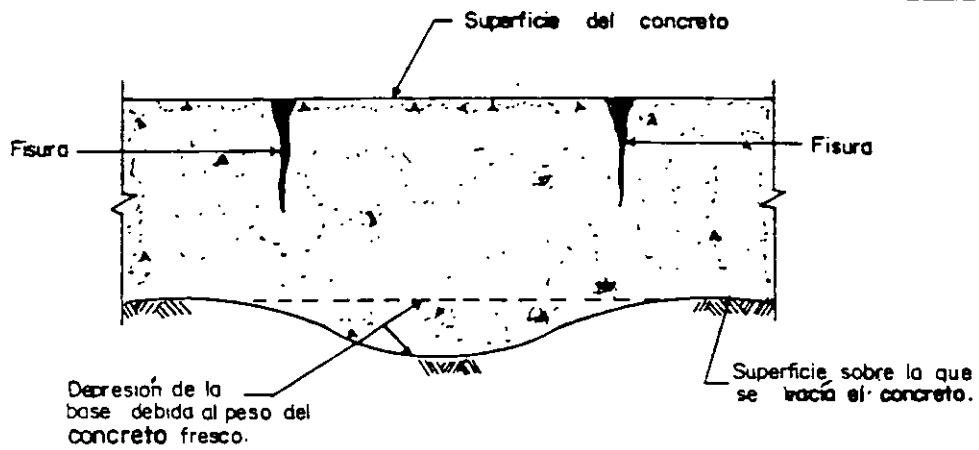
Fisura debida al asiento de la superficie sobre la que se traza durante la construcción
